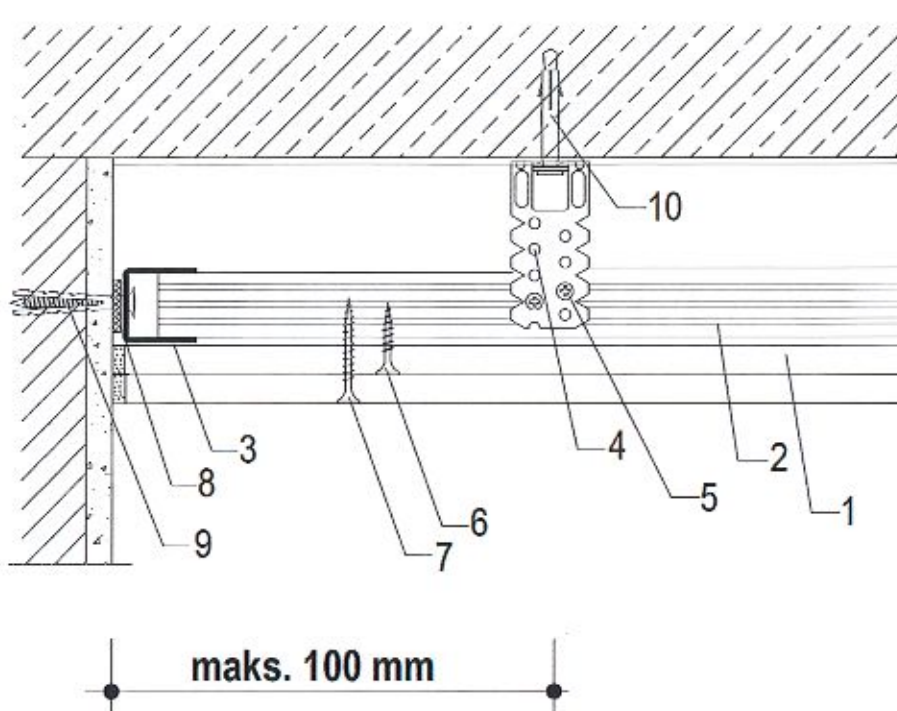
Widok sufitu podwieszanego – konstrukcja krzyżowa jednopoziomowa
